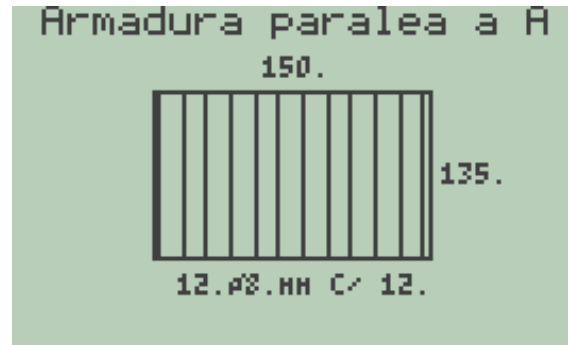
Sapata isolada - Detalhe da sapata - Armadura paralela a A.
